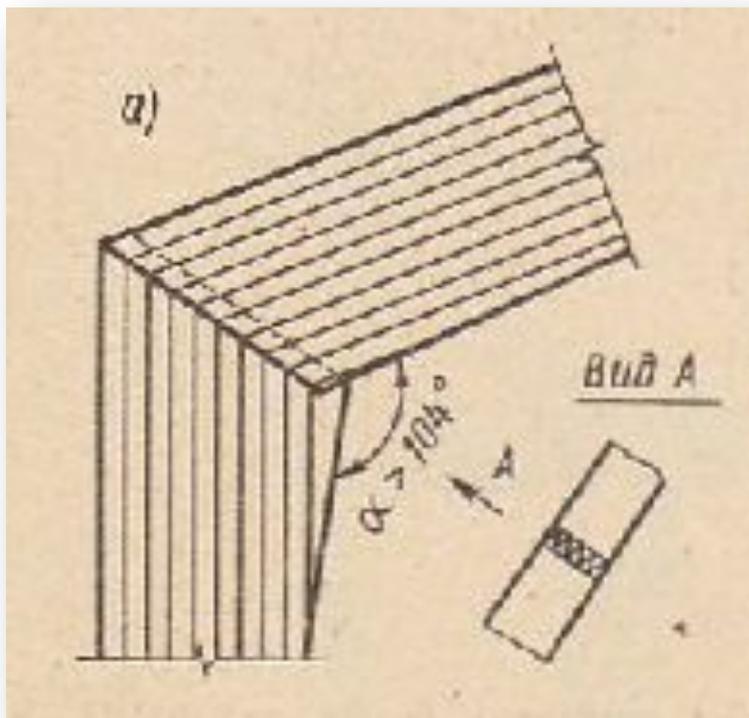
Соединение ригеля и стойки накладками из фанеры
